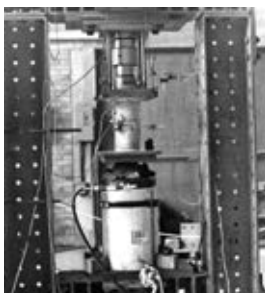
Ensayo de compresión en probetas de concreto.
